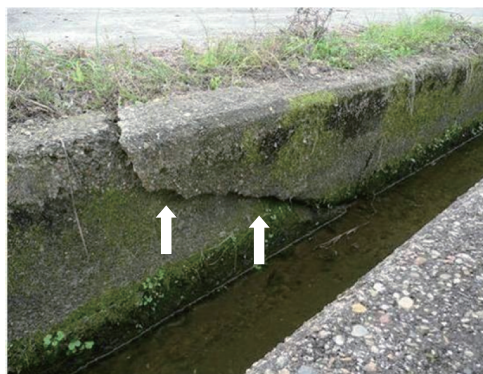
外力（車両荷重）により発生したひび割れ
